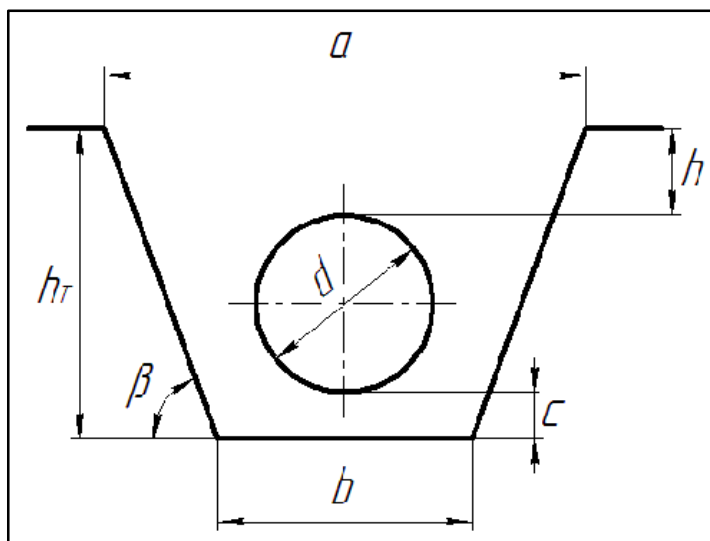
Поперечный профиль траншеи трубопровода
